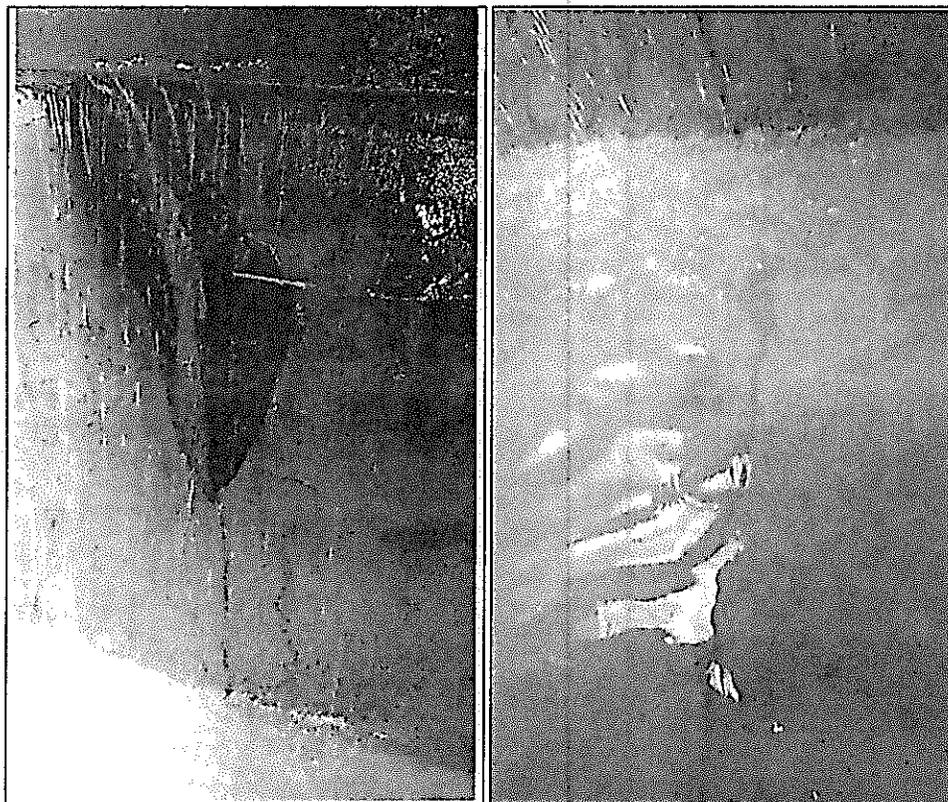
(Izq.) Grieta 5 mm en el muro, desprendimiento lechada de protección y revoque. (Der) Grieta en la losa de 7 mm en todo el sentido longitudinal.
